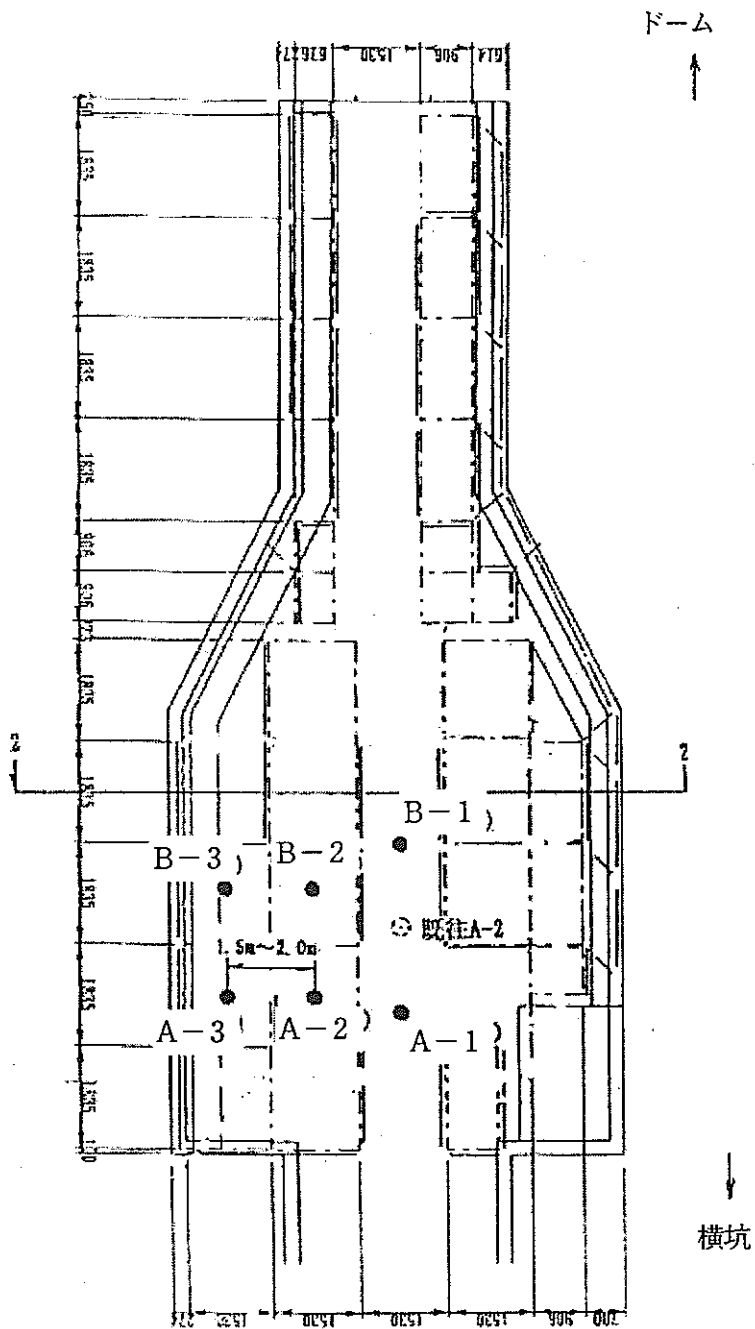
試錐孔配置平面図 (GL-50 m の横坑内)
